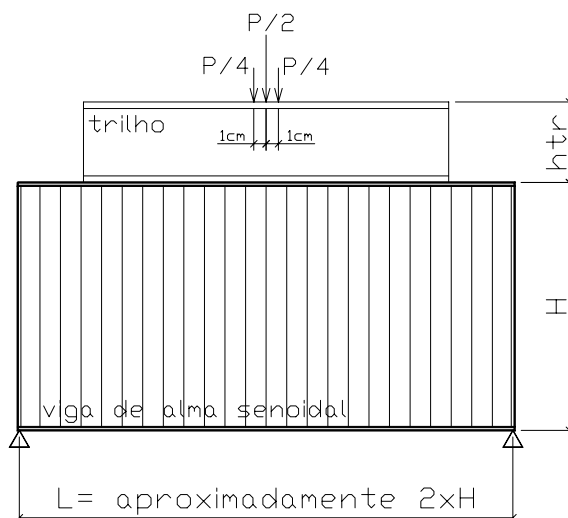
Carregamento aplicado nas vigas modeladas
